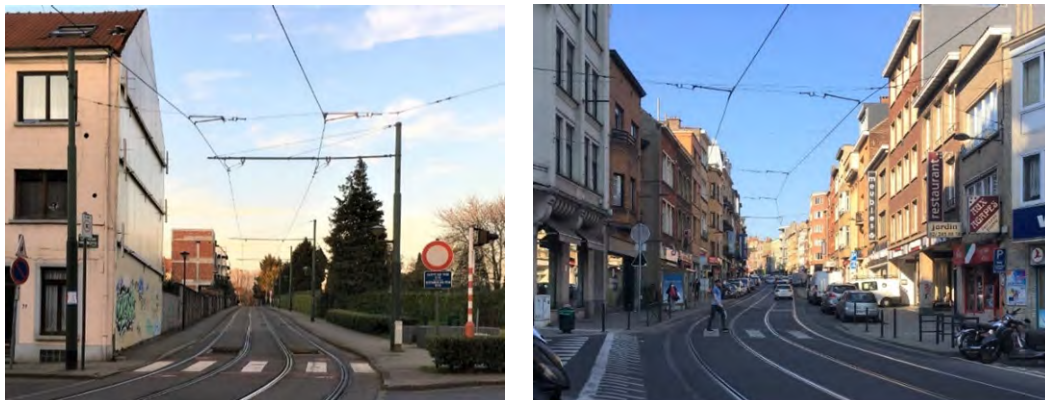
Caténares raccordées à des poteaux (à gauche, rue Fonson) ou aux façades (à droite, chaussée de Helmet)
